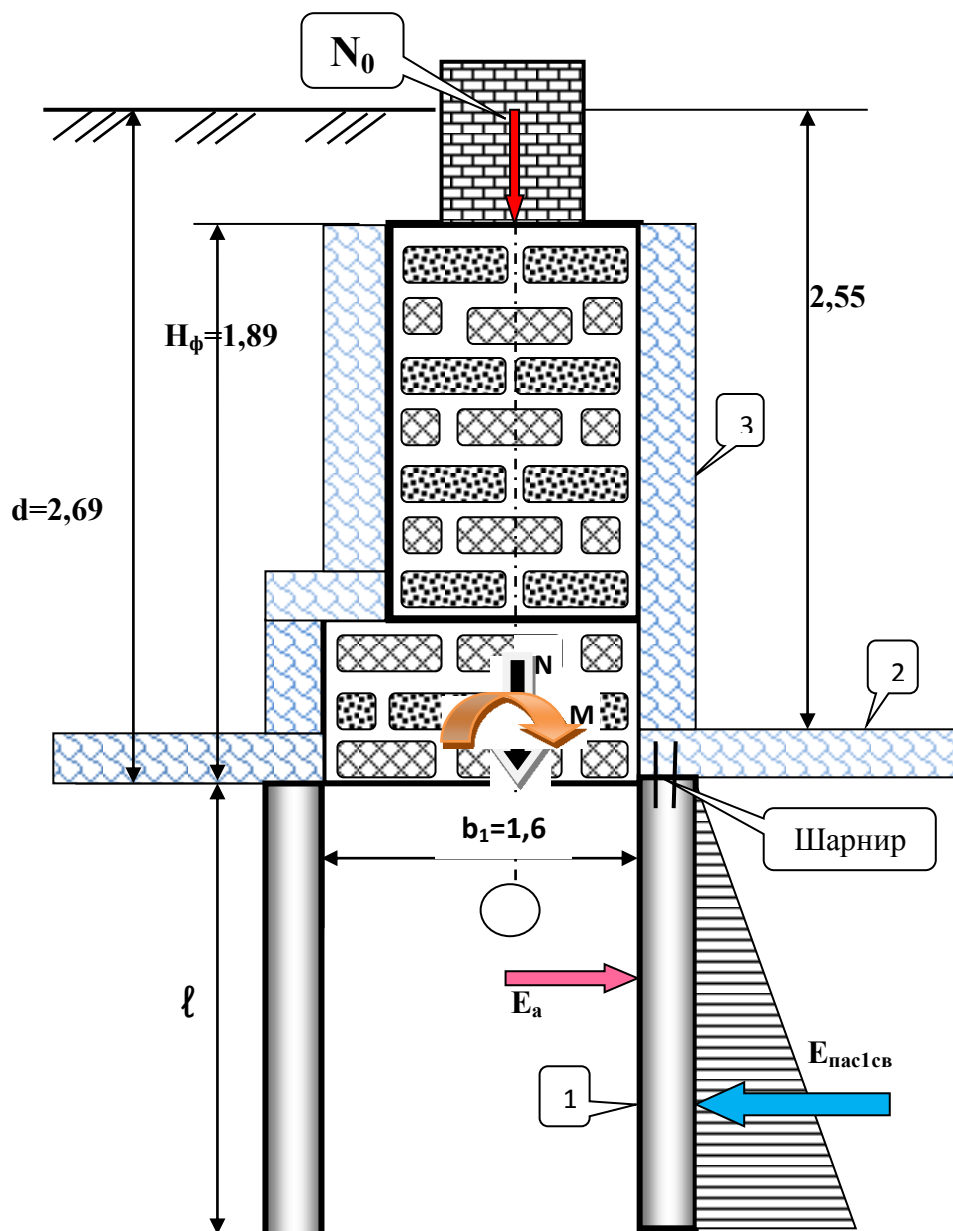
Схема поперечного сечения фундамента реконструируемого здания, с понижением отметки пола существующего подвала, и частичной подрезкой подошвы фундамента, (использованы конструктивные элементы усиления основания).
